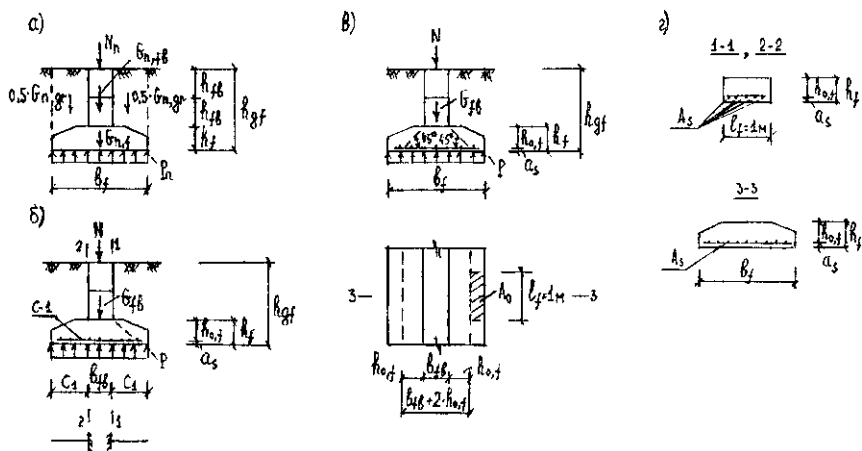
Расчётные схемы центрально нагруженного ленточного фундамента под несущие стены: а – определение размеров подошвы фундамента, б – расчёт на прочность по нормальным и наклонным сечениям, в – расчёт на продавливание, г – поперечные сечения
